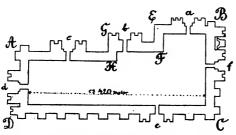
Grundriß ber Festung bes Gubea von Lagasch.
